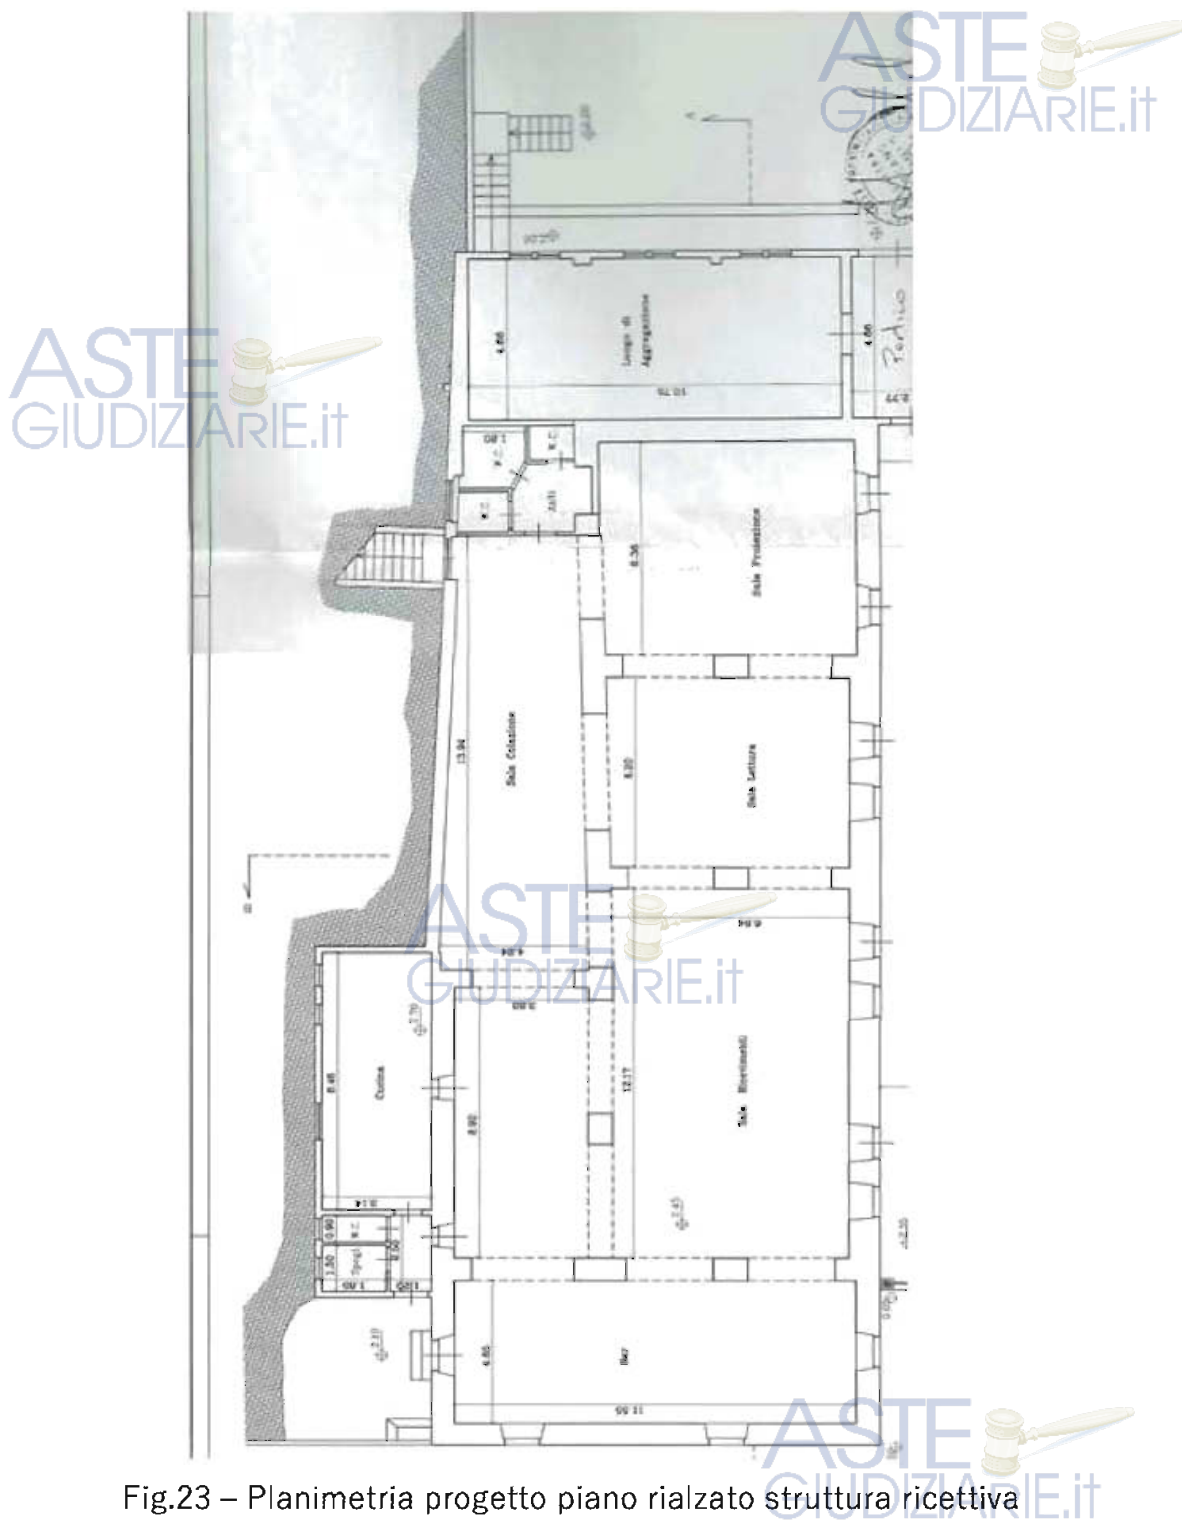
Planimetria progetto piano rialzato struttura ricettiva
